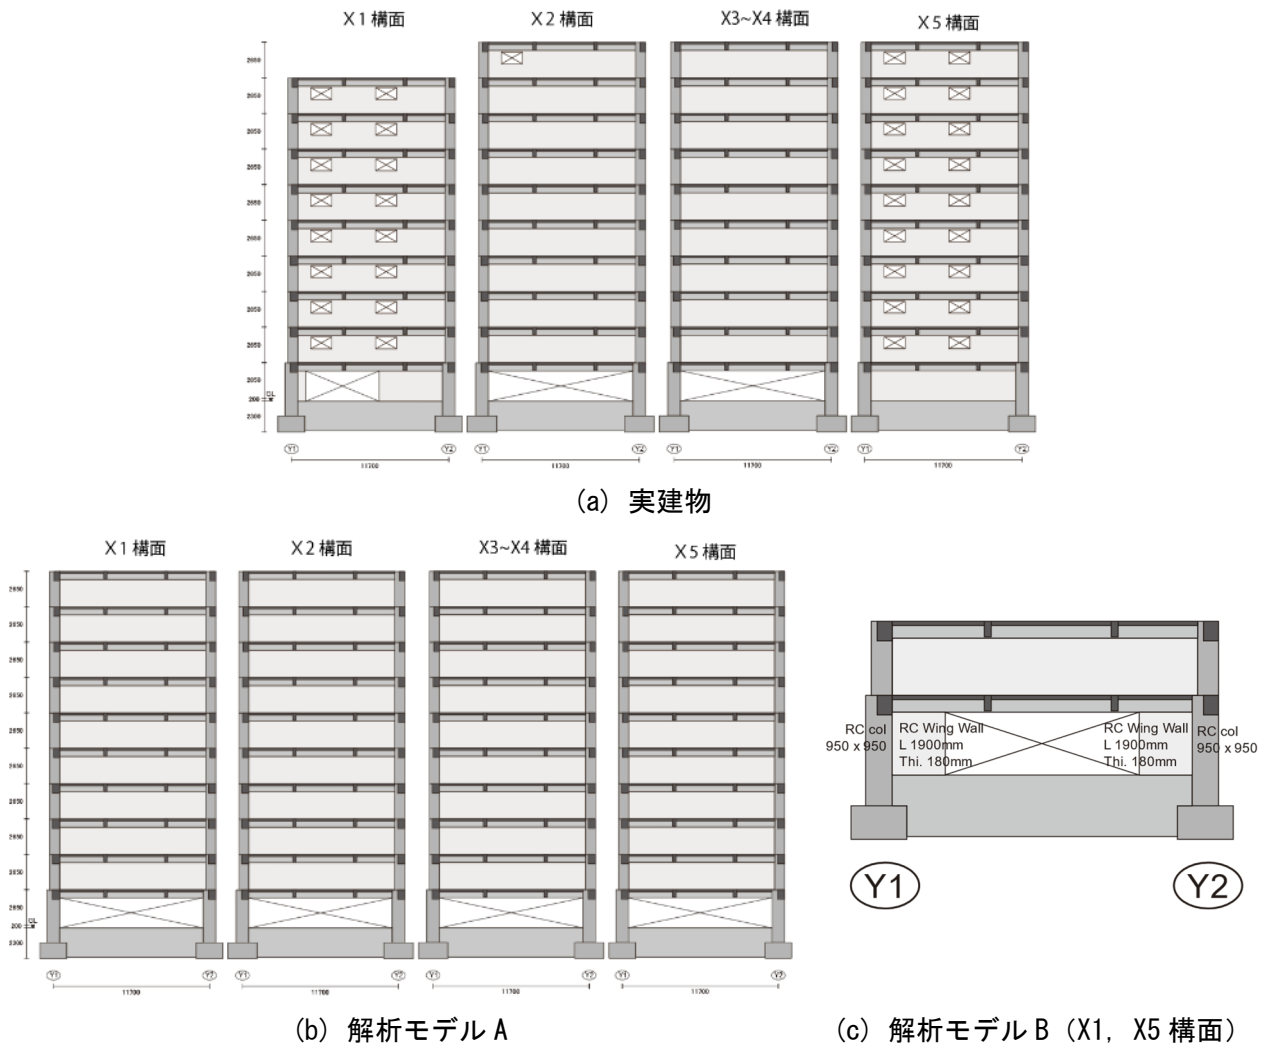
軸組図 (梁間方向) (単位 : mm)
